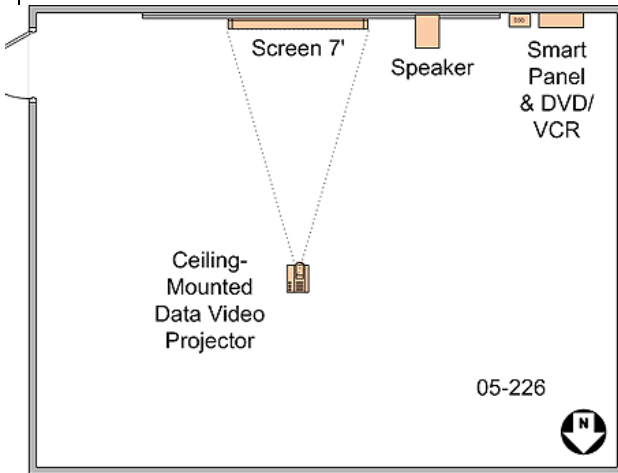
تجهيزات الفصل الدراسي
